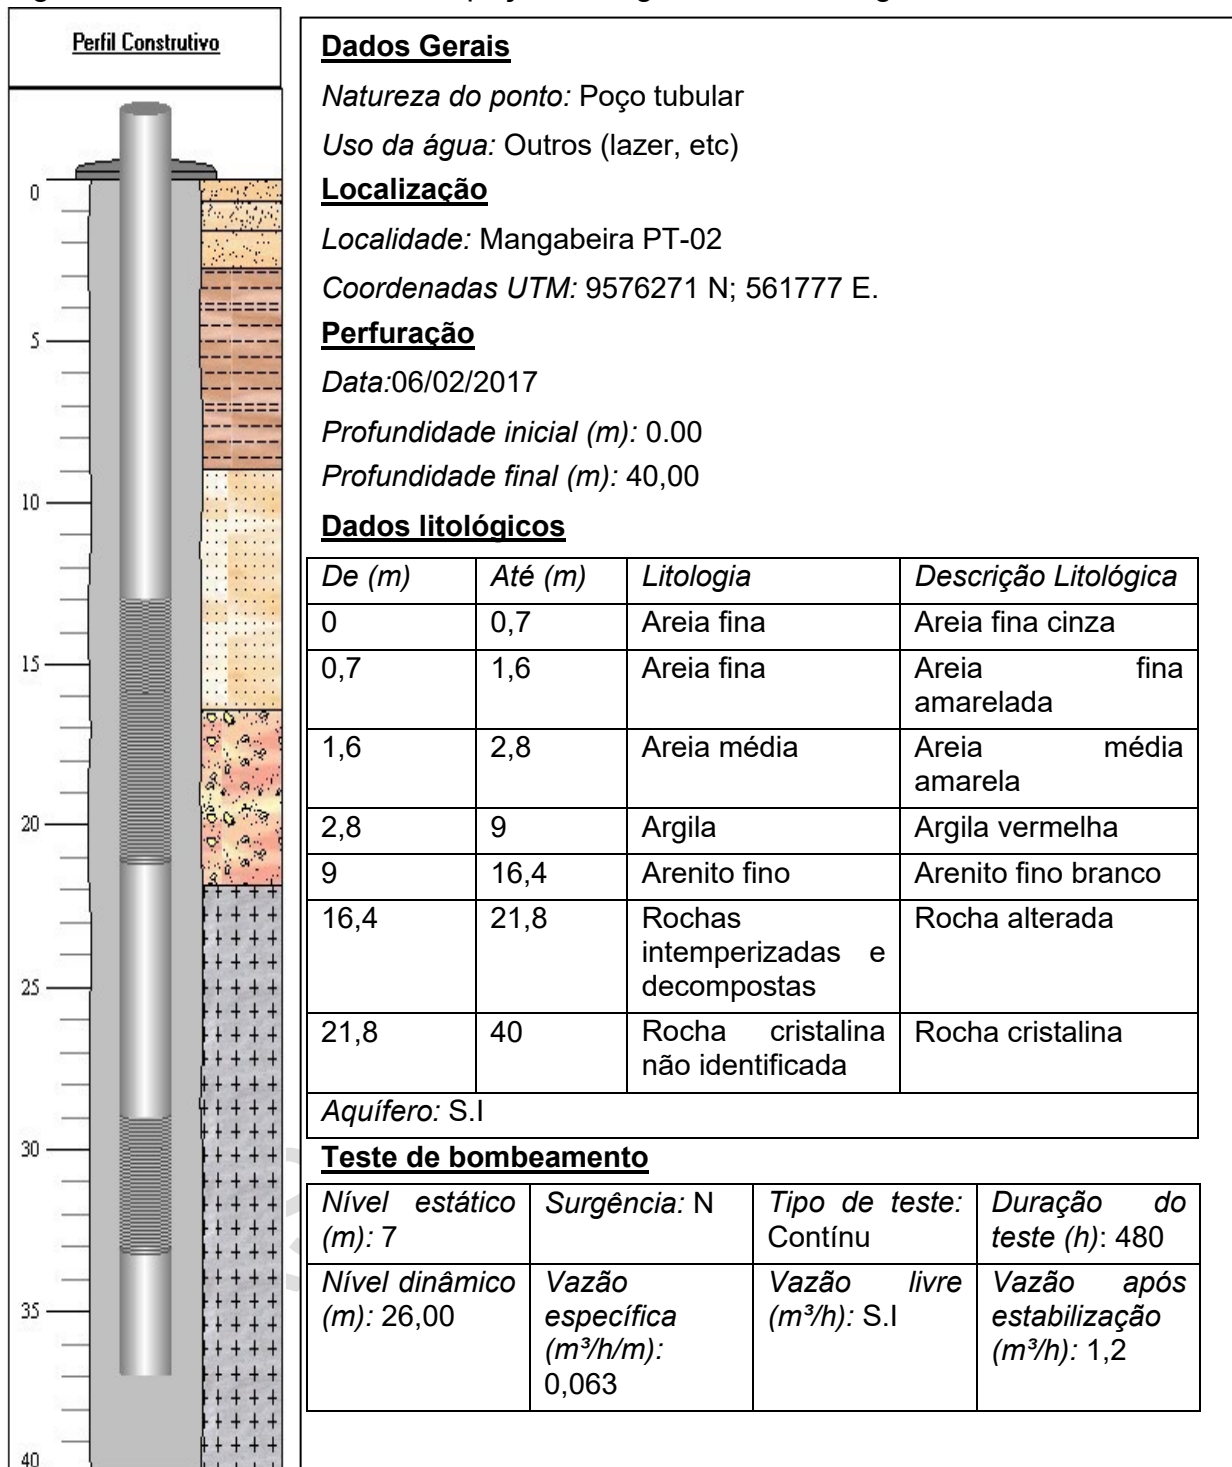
Perfil construtivo do poço 3: margem leste da Lagoa da Precabura.
